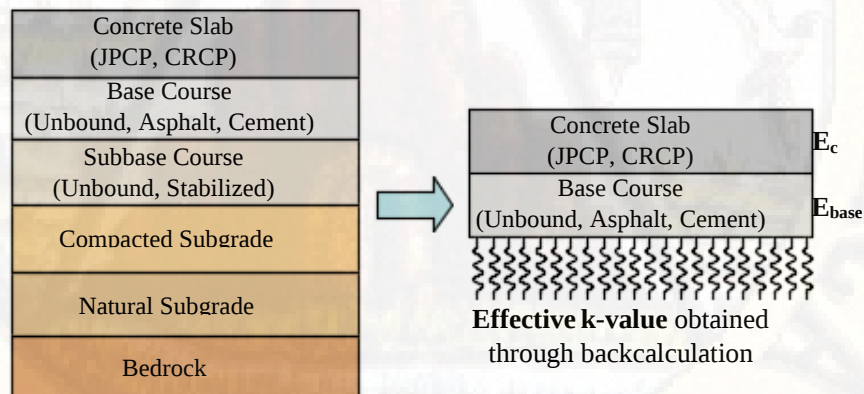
Modelo estructural para el cálculo de pavimentos rígidos
